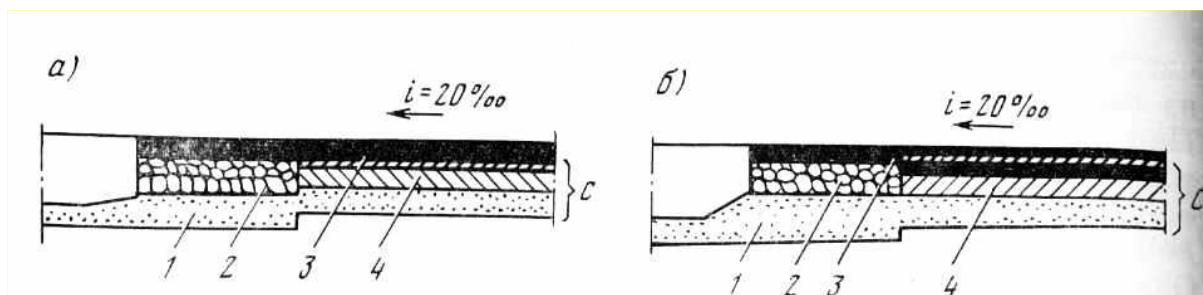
Схема уширения старого покрытия с расширением основания старой дорожной одежды: а - усиление облегченного усовершенствованного покрытия; б - усиление асфальтобетонного покрытия; 1 - песчаный слой; 2 - щебеночное основание; 3 - асфальтобетонный слой на всю ширину проезжей части; 4 - основание старой дорожной одежды; 5 — существующая дорожная одежда
